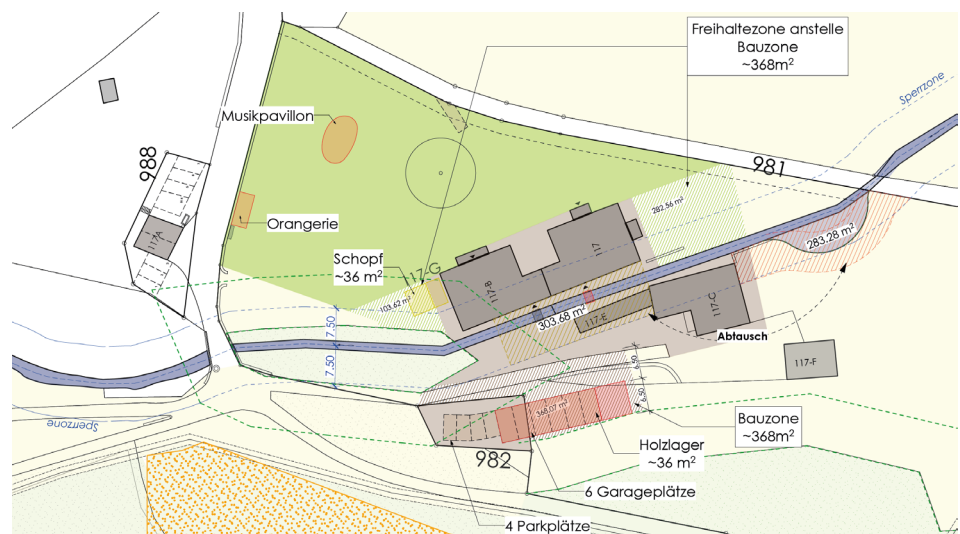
Situationsplan Gutsbetrieb Mühle mit vorgesehenen Zonenanpassungen
